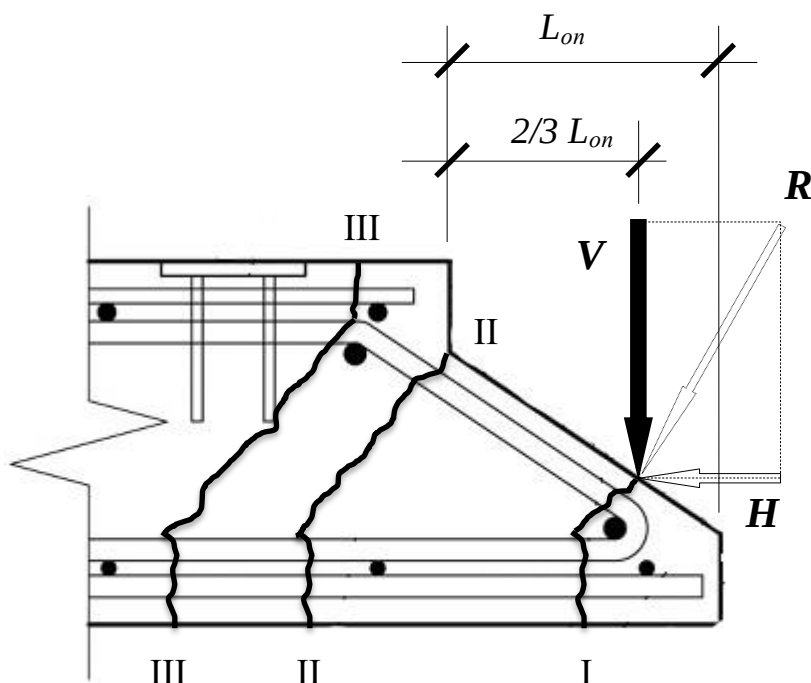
Розрахункова схема опорної частини розроблених плит збірного безбалкового перекриття.
